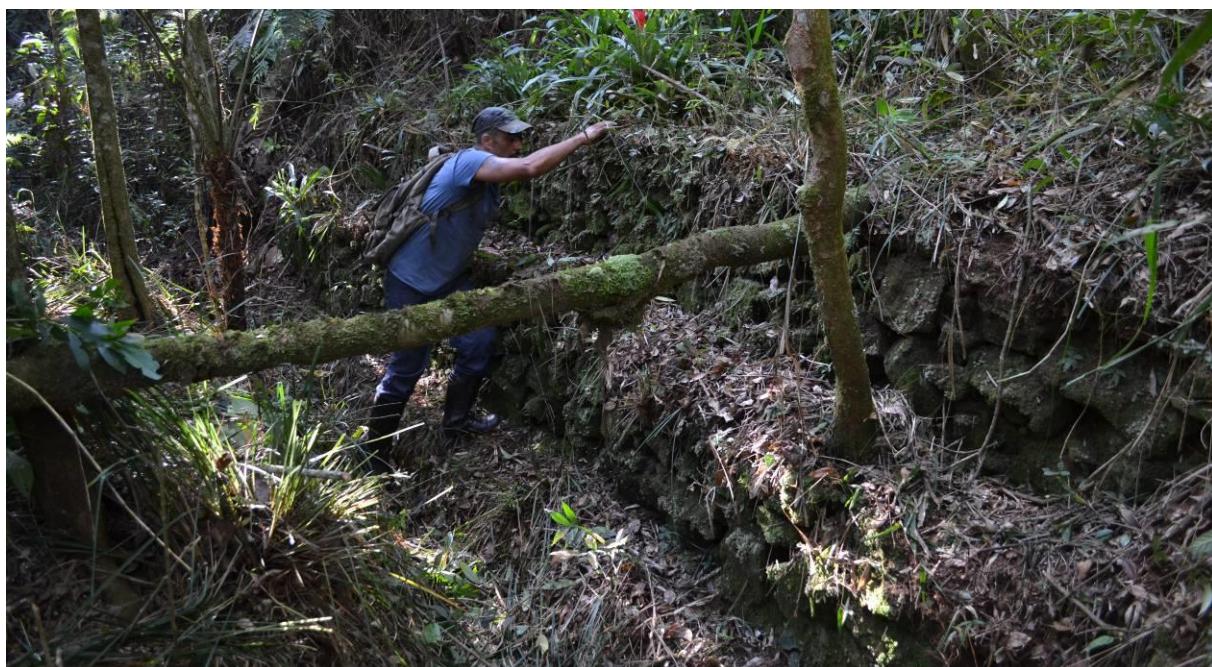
Trecho onde a alvenaria de pedra-seca se encontra do lado interno do aqueduto da Lagoa Azul.
